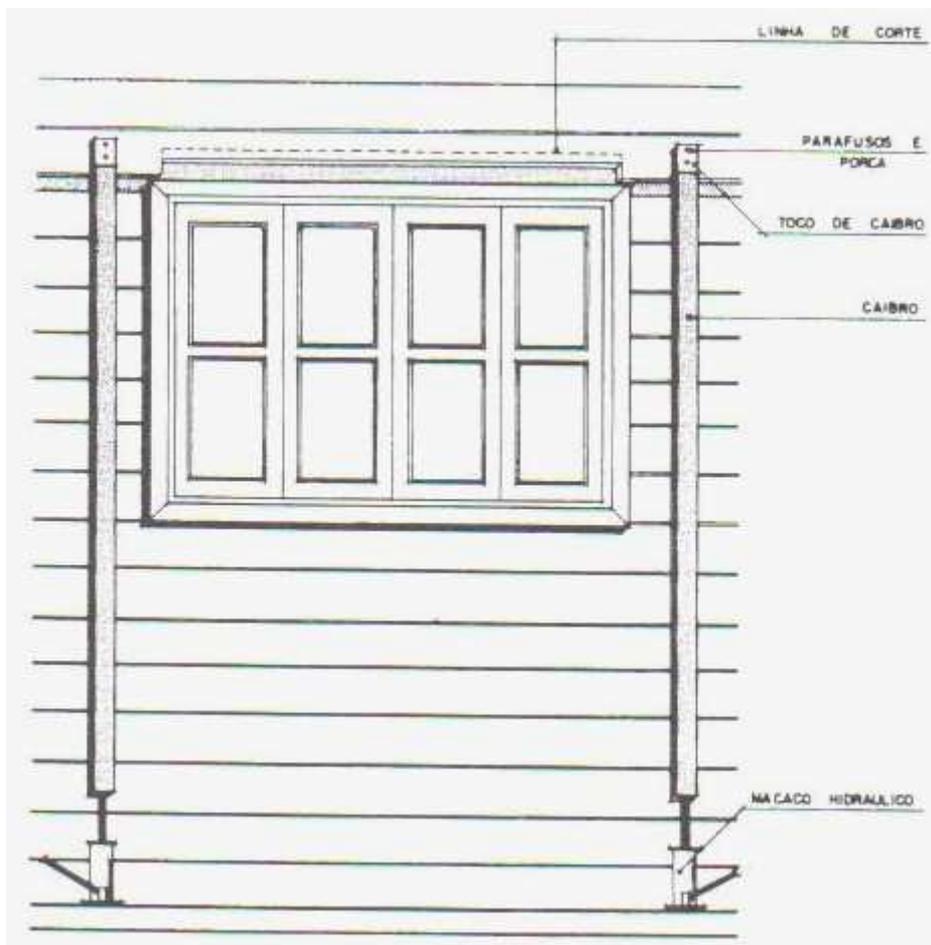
Casema (1998) - Aumento ou execução do recorte superior.
